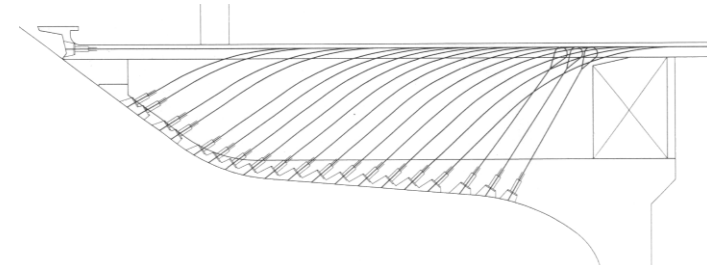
Tensores de las vigas inferiores de hormigón postesado
